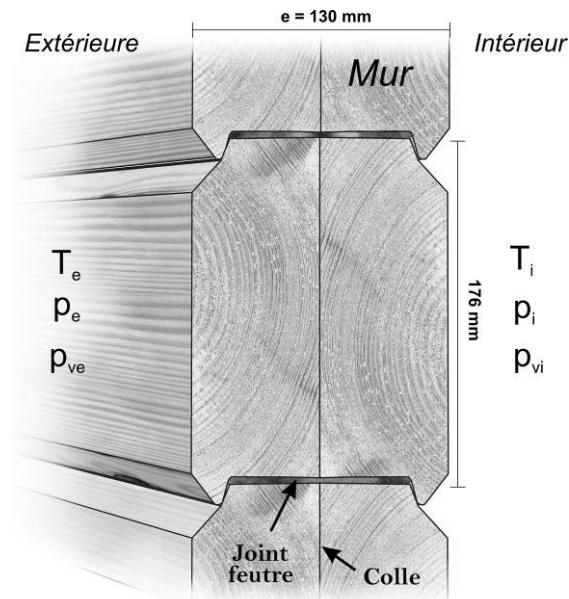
Mur en bois massif contre-collé verticalement avec joint de feutre entre madriers
